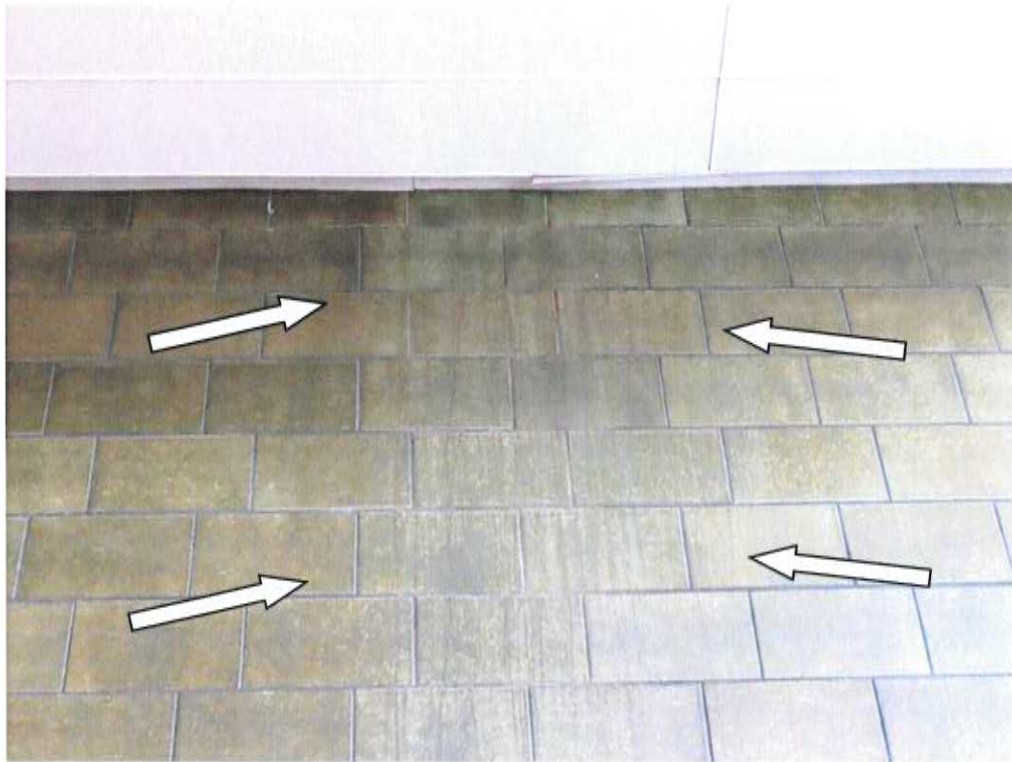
Wände im Dachbereich: Spuren von Wasserschaden an Südwand
